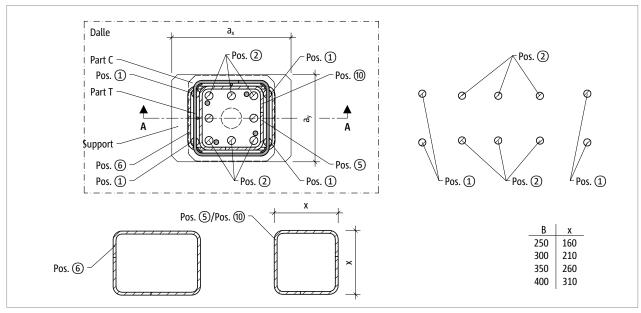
Schöck Sconnex® type P : renforcement sur site dans la section du poteau
